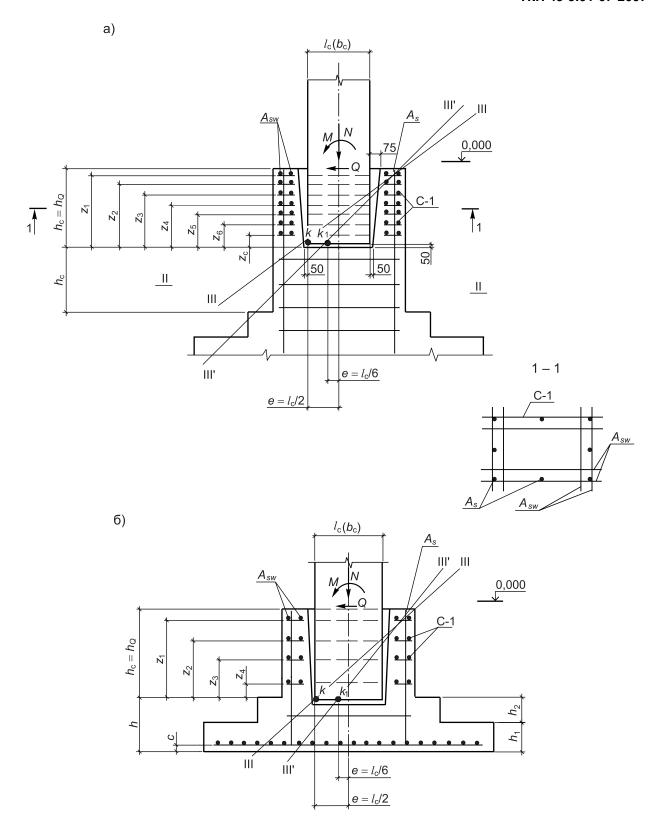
Расчетная схема стаканной части фундамента:
